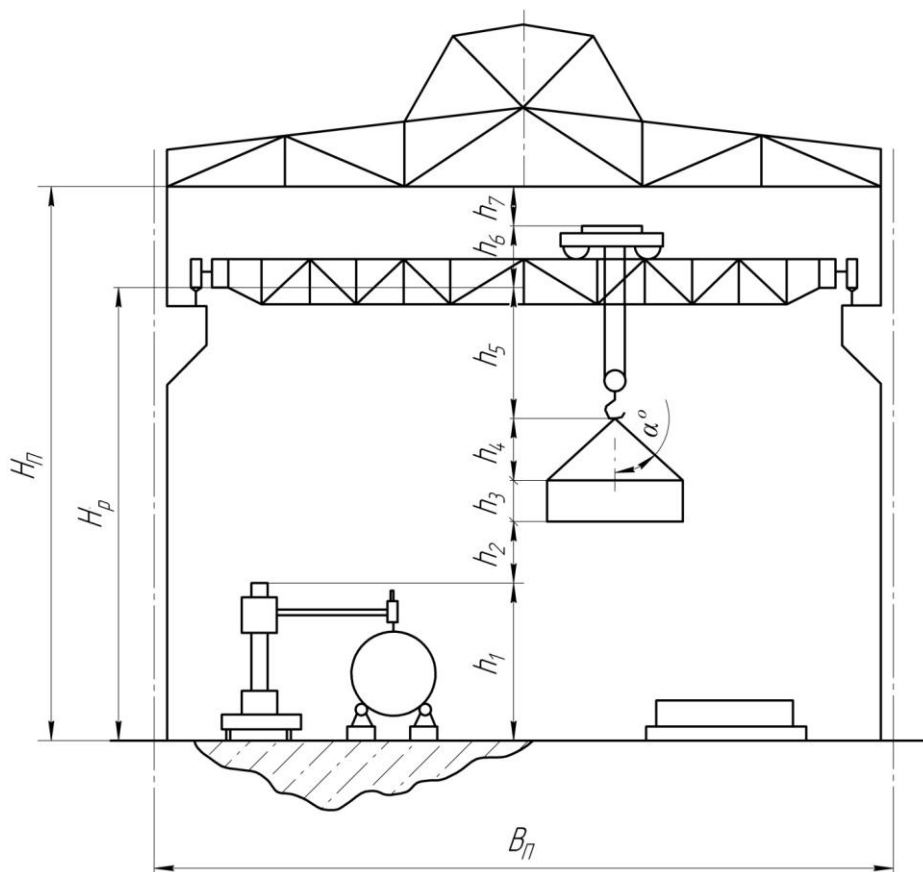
Схема разреза сборочно-сварочного цеха для расчета высоты пролета при наличии верхнего транспорта (крана)
